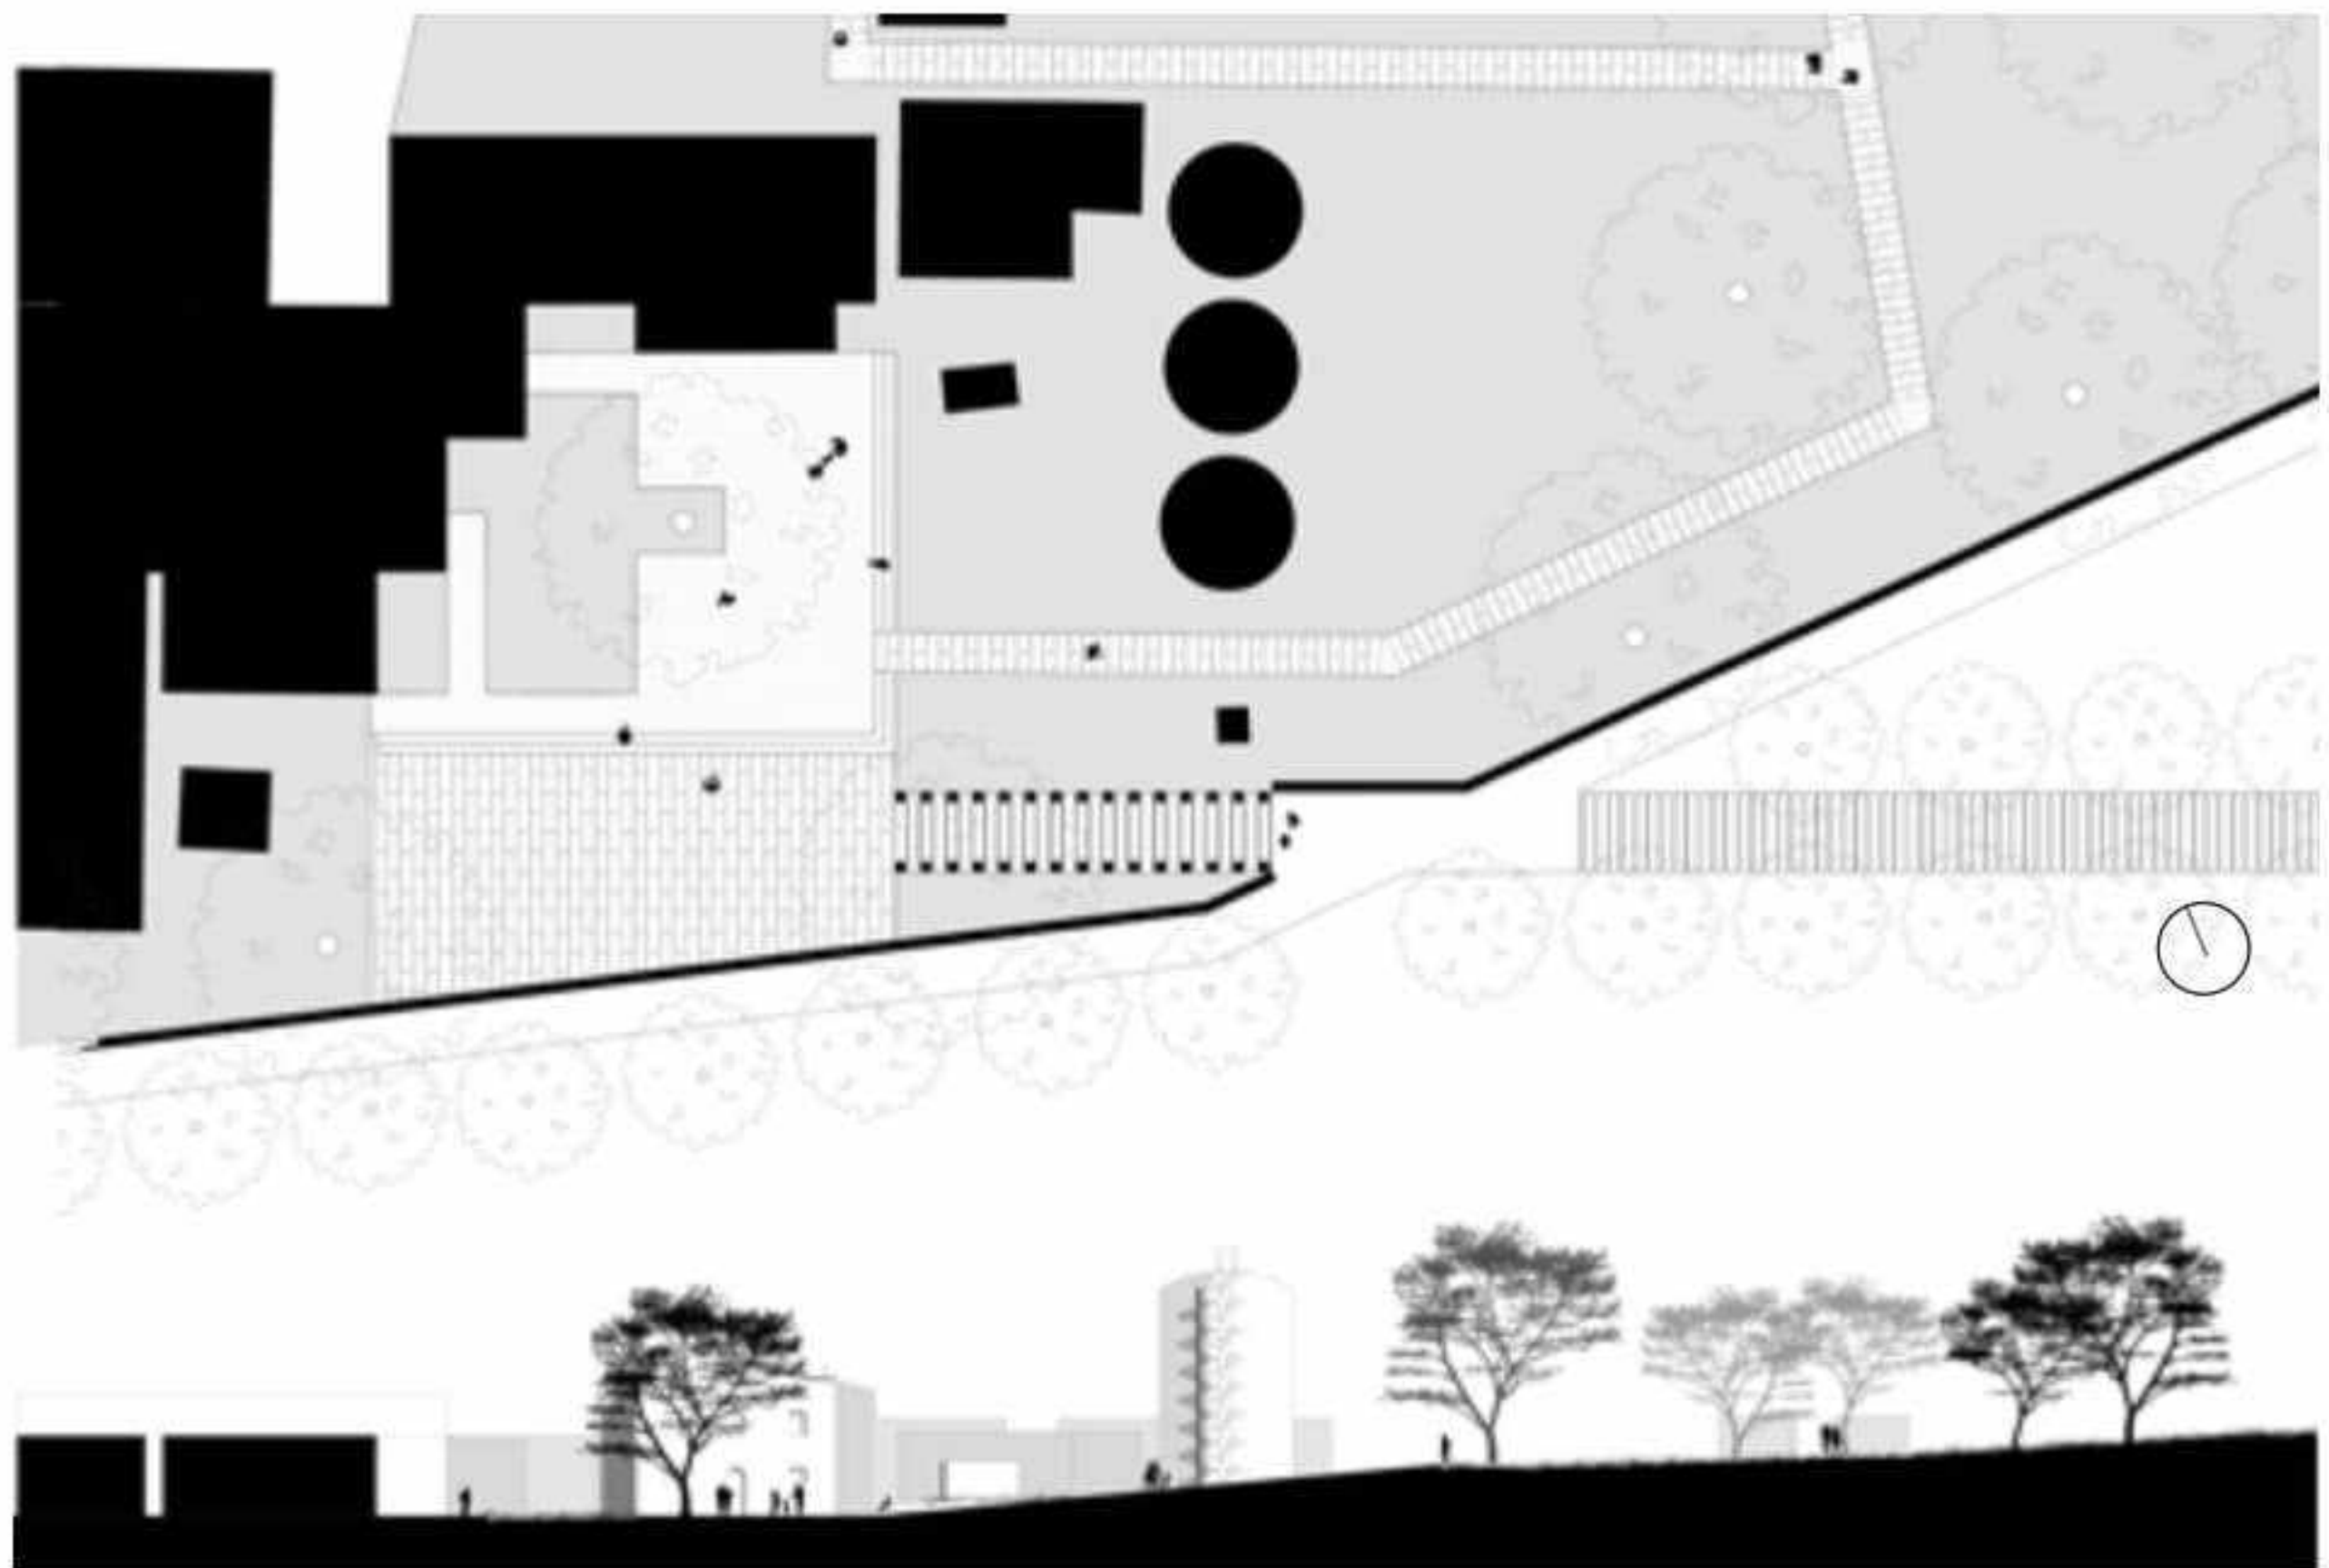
Progetto per l'area di San Martino, pianta e sezione.
